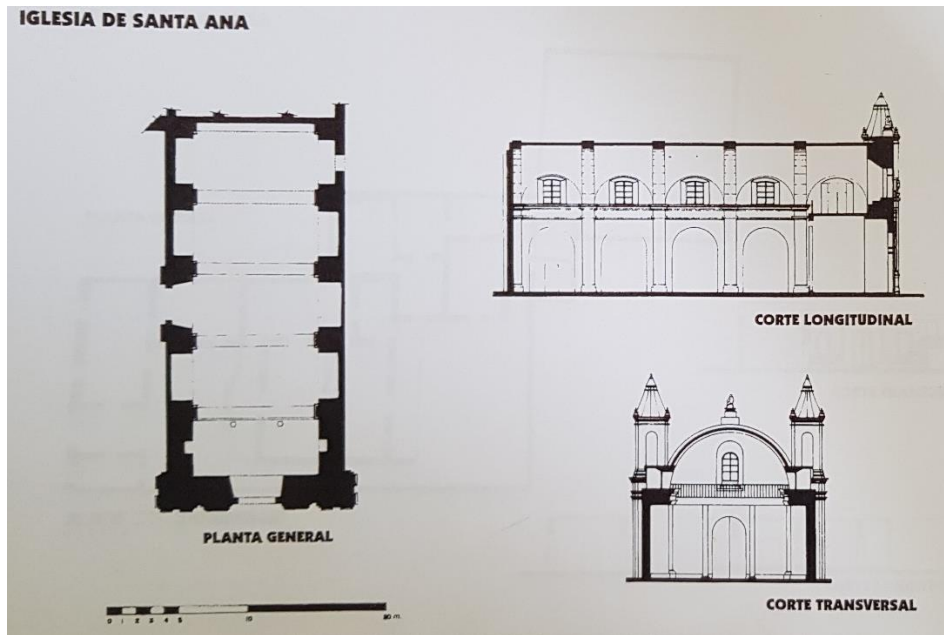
Plano en planta y cortes de la iglesia Santa Ana.
